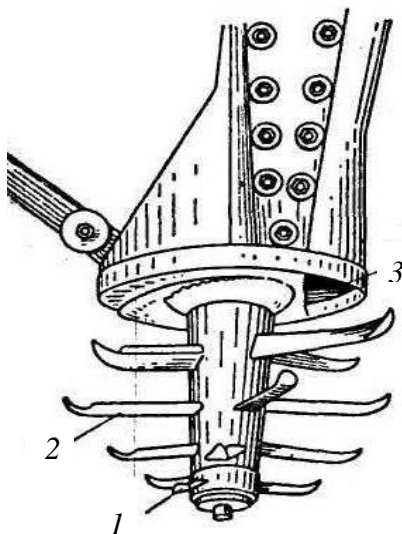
Разрыхлитель с винтовой фрезой.
